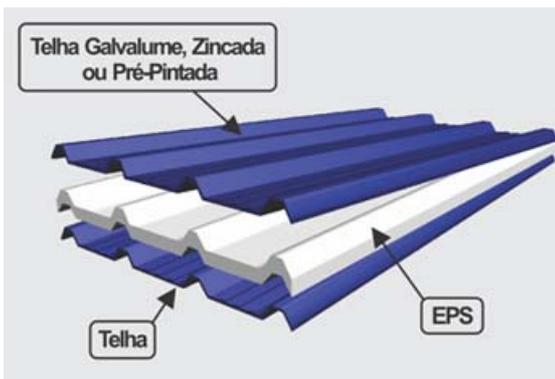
Telha metálica tipo sanduíche. Fonte: <http://www.acometal.com>.
